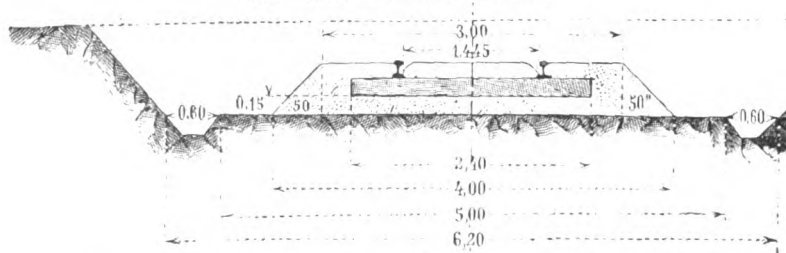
Billige Regelspur I mit Fahrzeugen der Hauptbahnen. Eingeschränkter Einschnitt in verwittertem Fels
